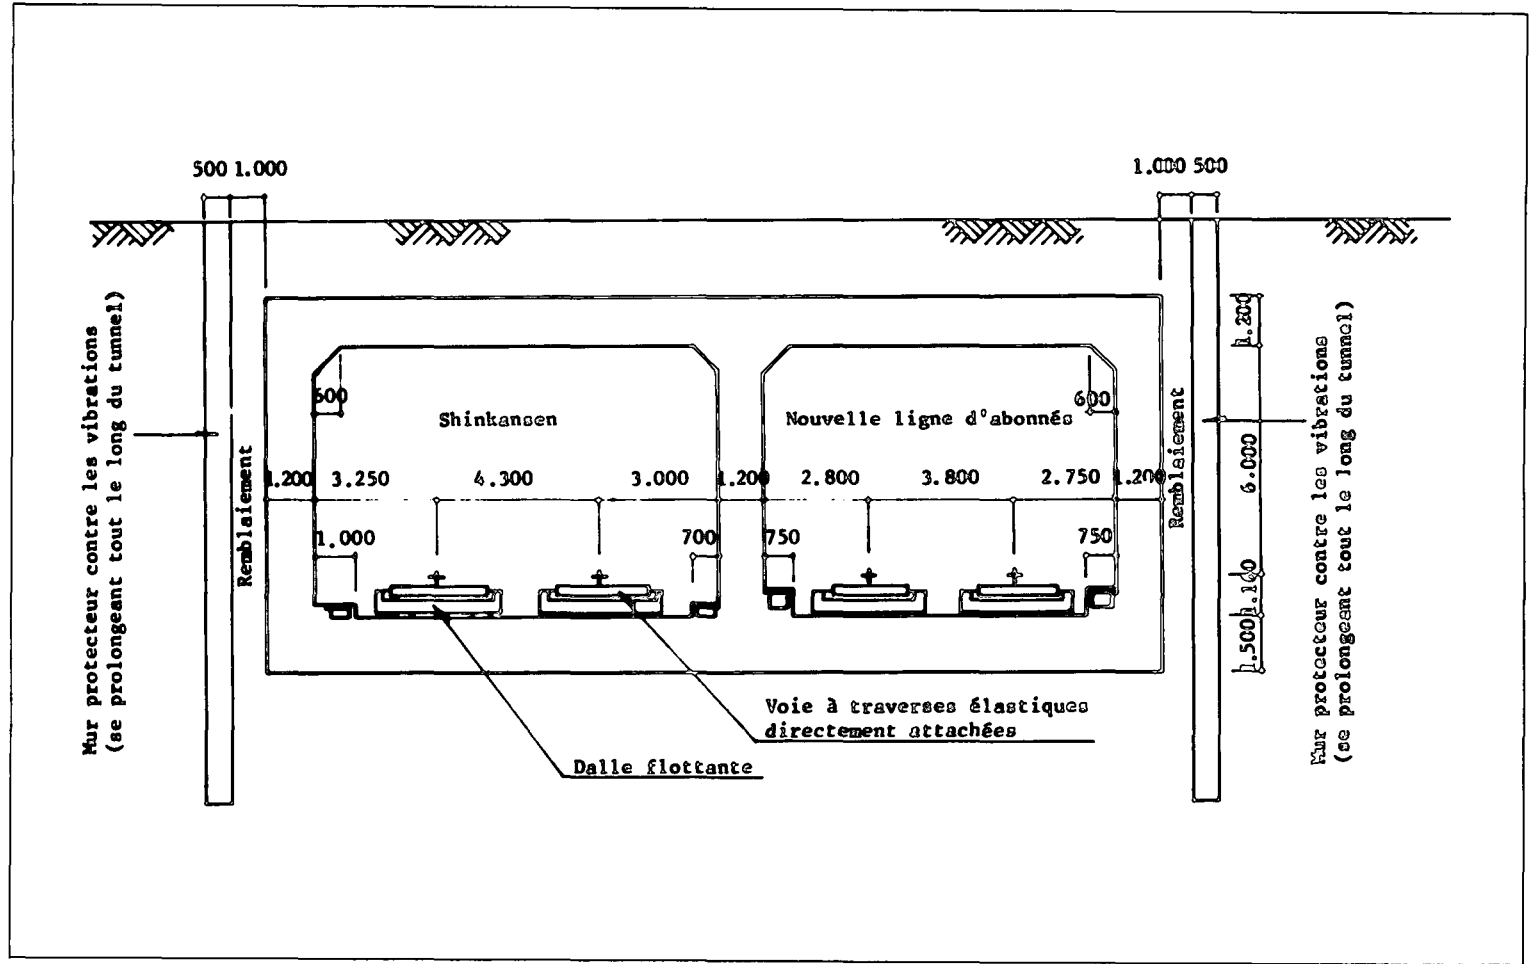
Coupe transversale du tunnel d'Akabanedai.
